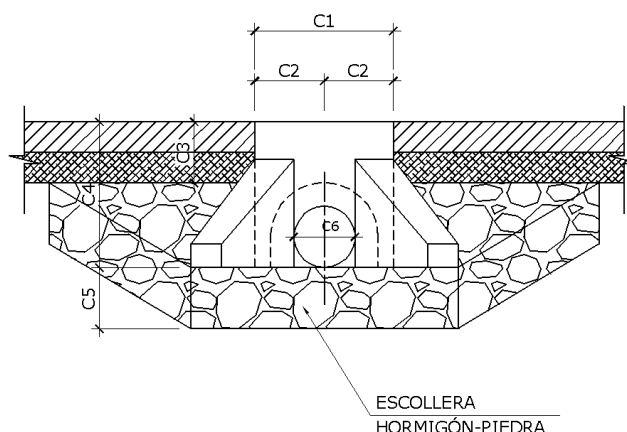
Alzado de ODT en su salida con embocadura de aleta y escollera de piedra.
